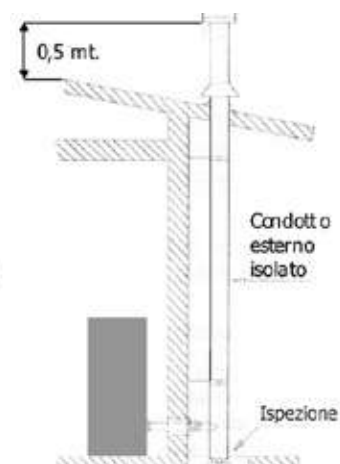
collegamento ad un condotto esterno con tubo isolato o doppia parete
